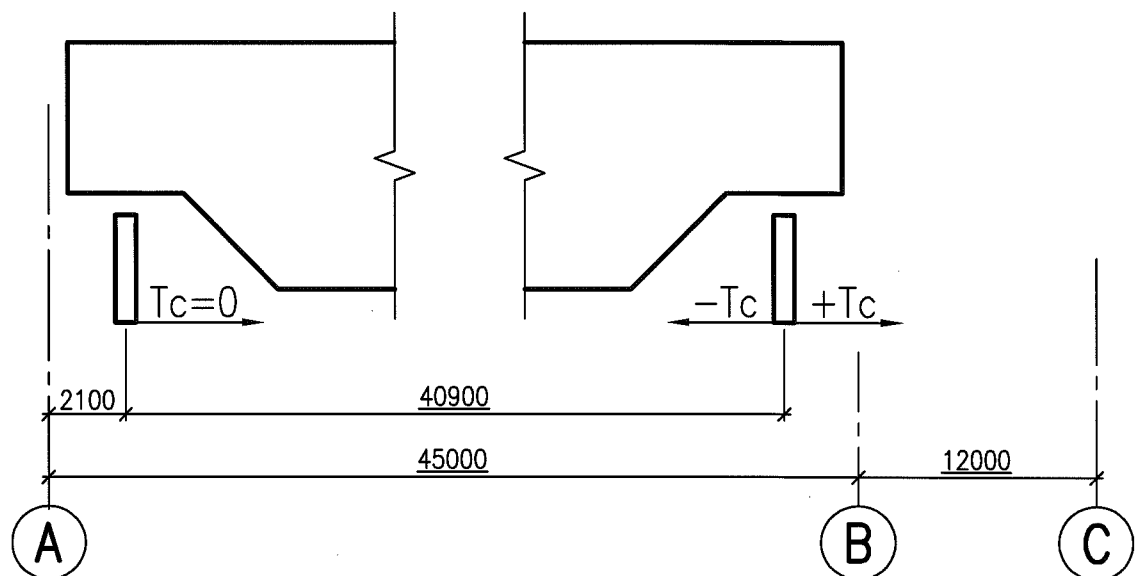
Схема распределения нагрузок на подкрановый рельс от крана грузоподъемностью  $Q=180 + 180/32$  т (Кран SMM20AE001)
